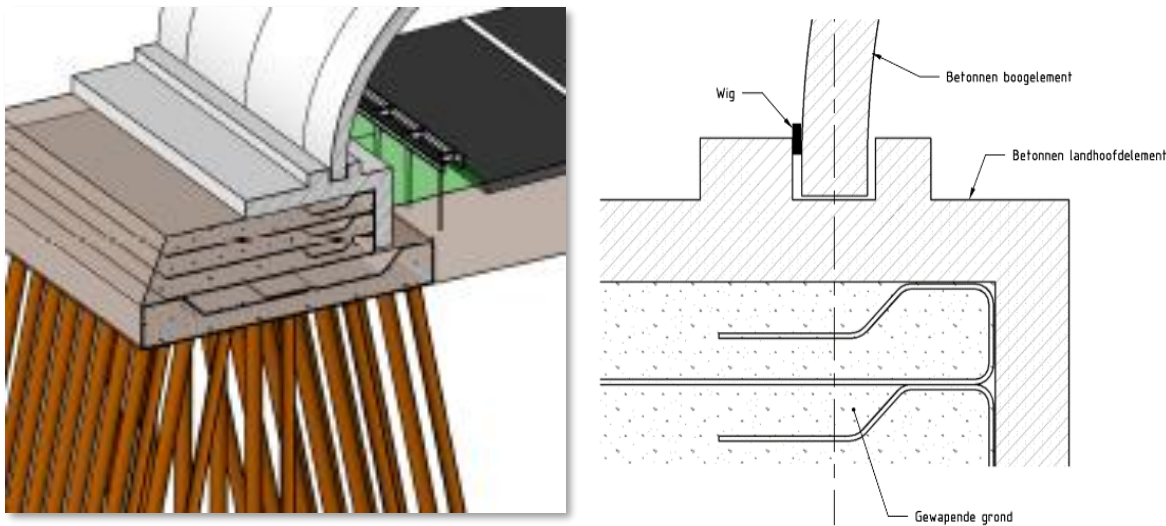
Demontabele verbinding tussen steunpunt - boogelement
